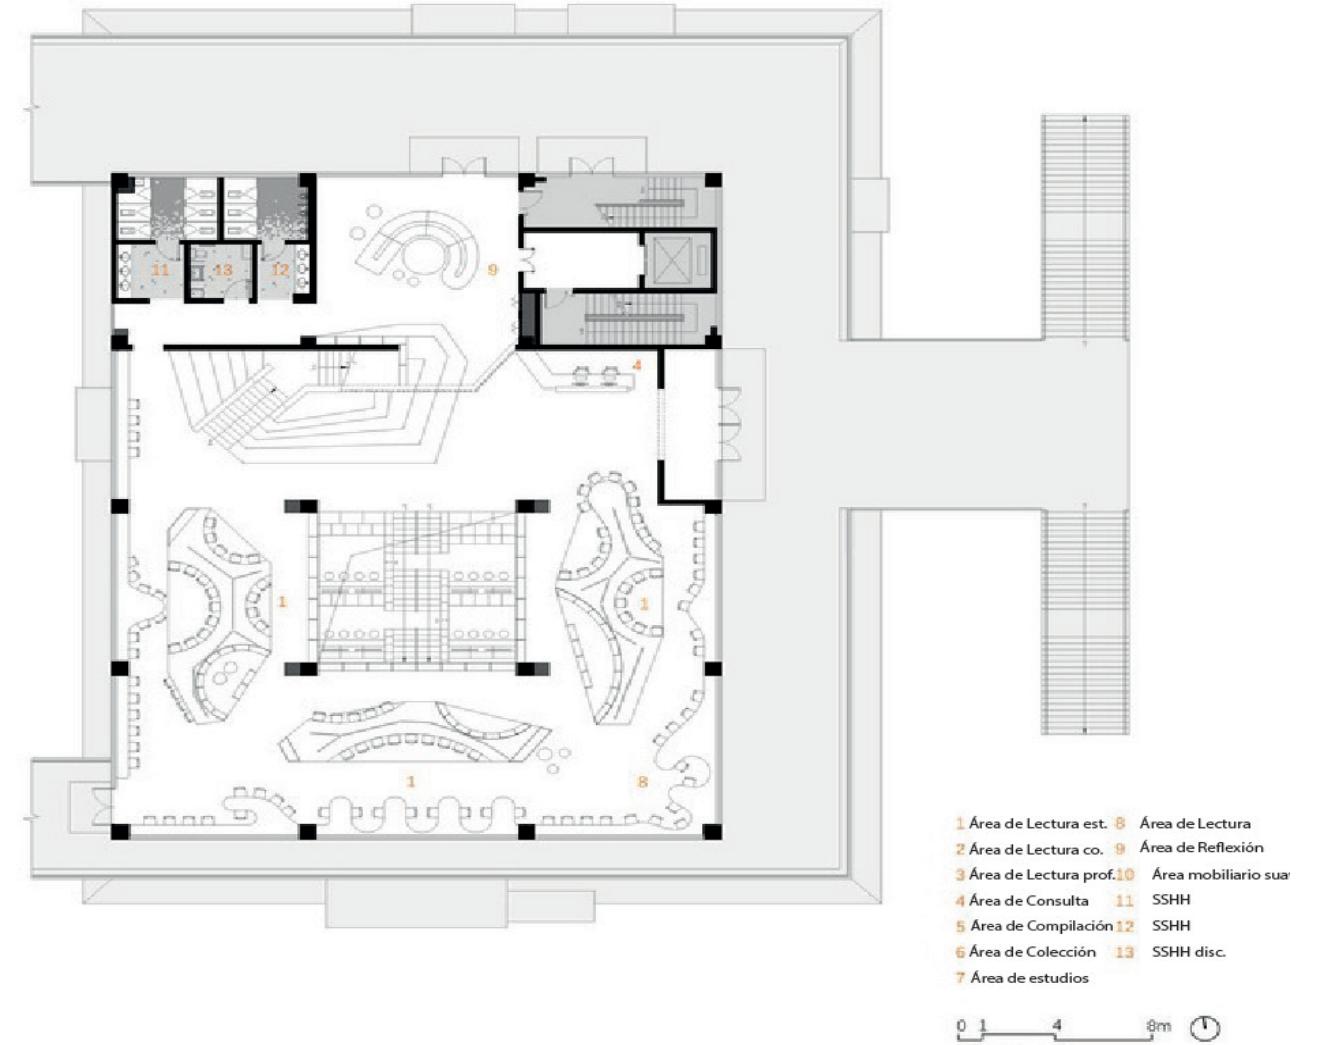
Primera Planta Alta, Biblioteca Escuela Hebi. Fuente: ArchDaily (2023)
